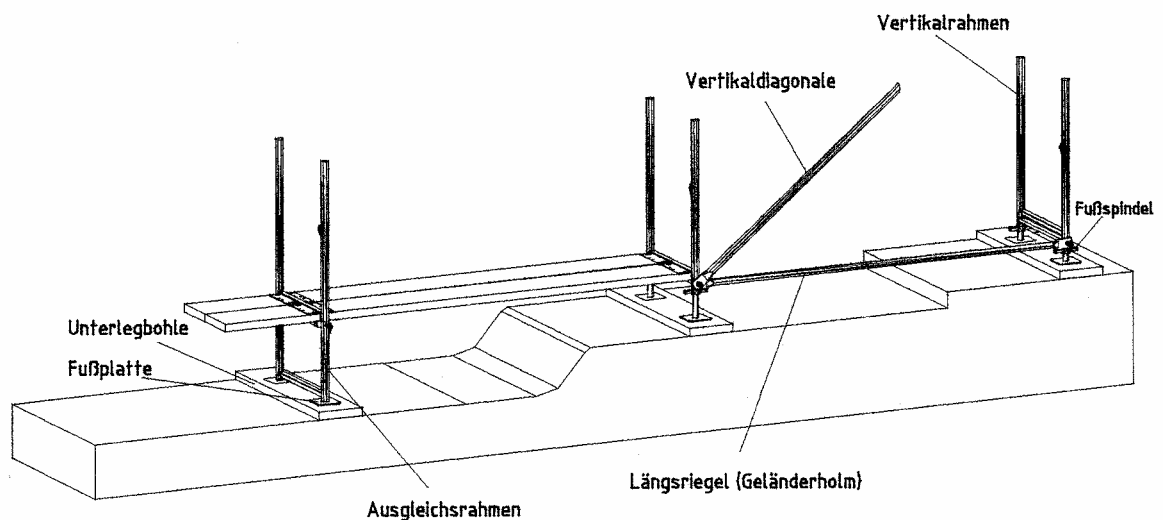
Aufbau mit vertikalem Ausgleichsrahmen
